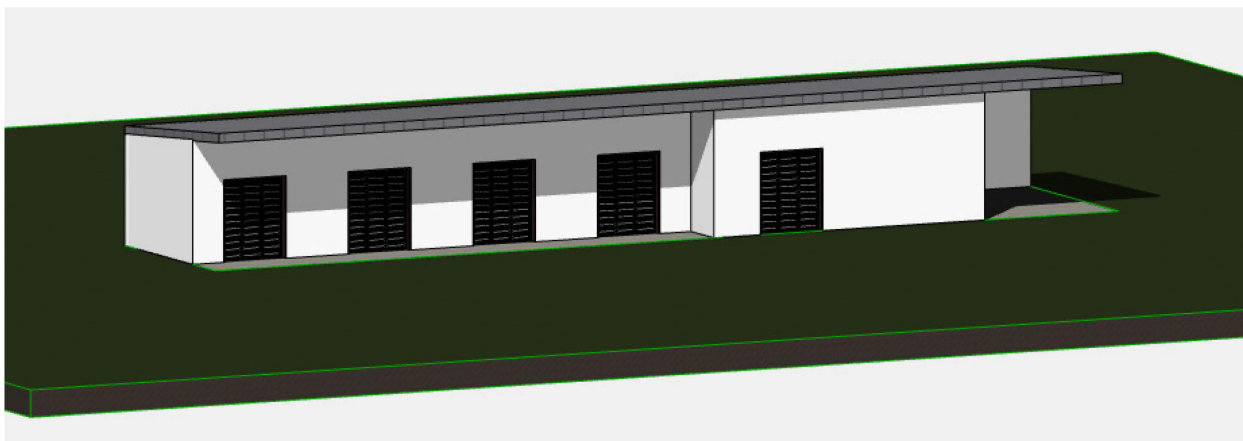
Dienstbürogebäude Dachvariante Pultdach-Pultdach
